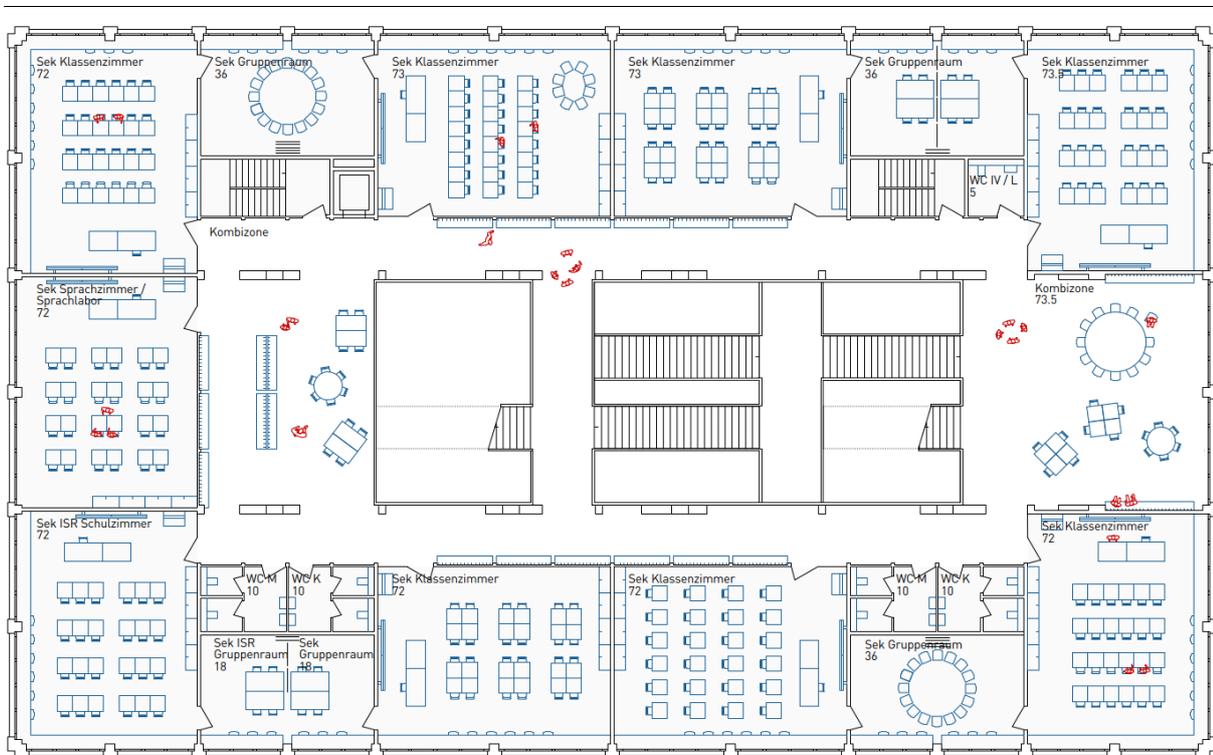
Grundriss 2. Obergeschoss Sekundarschule
